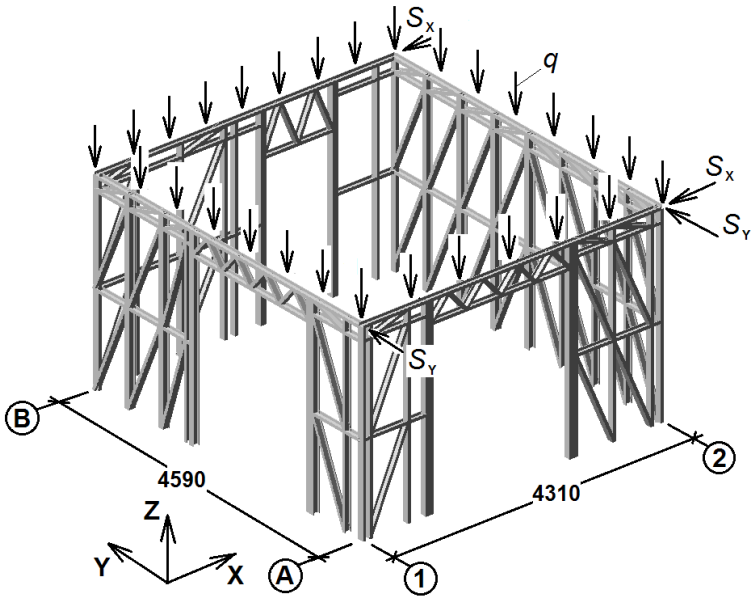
Схема приложения вертикальной и горизонтальной нагрузки (вдоль осей X и Y) на пространственный фрагмент здания при его испытаниях
